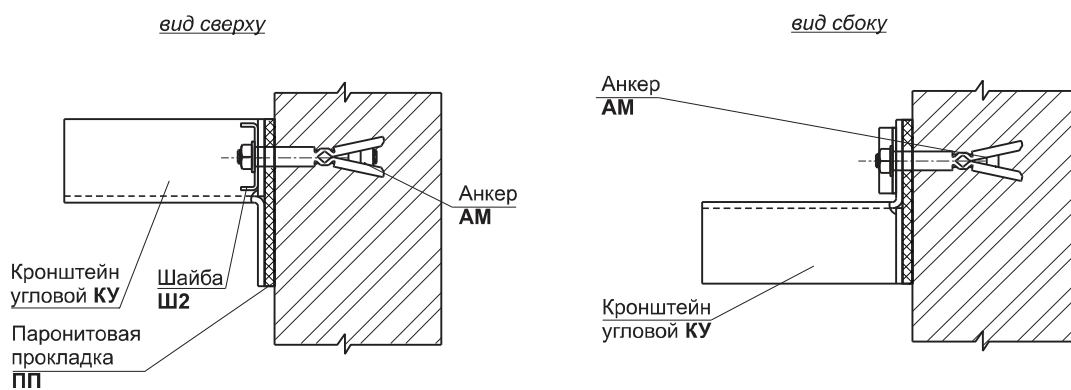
Узел крепления кронштейна КУ к стене одним анкером.
